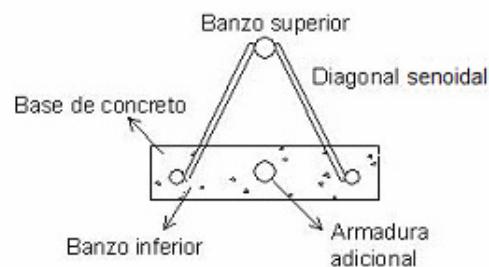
Seção transversal da vigota treliçada – DAVID (2007)
